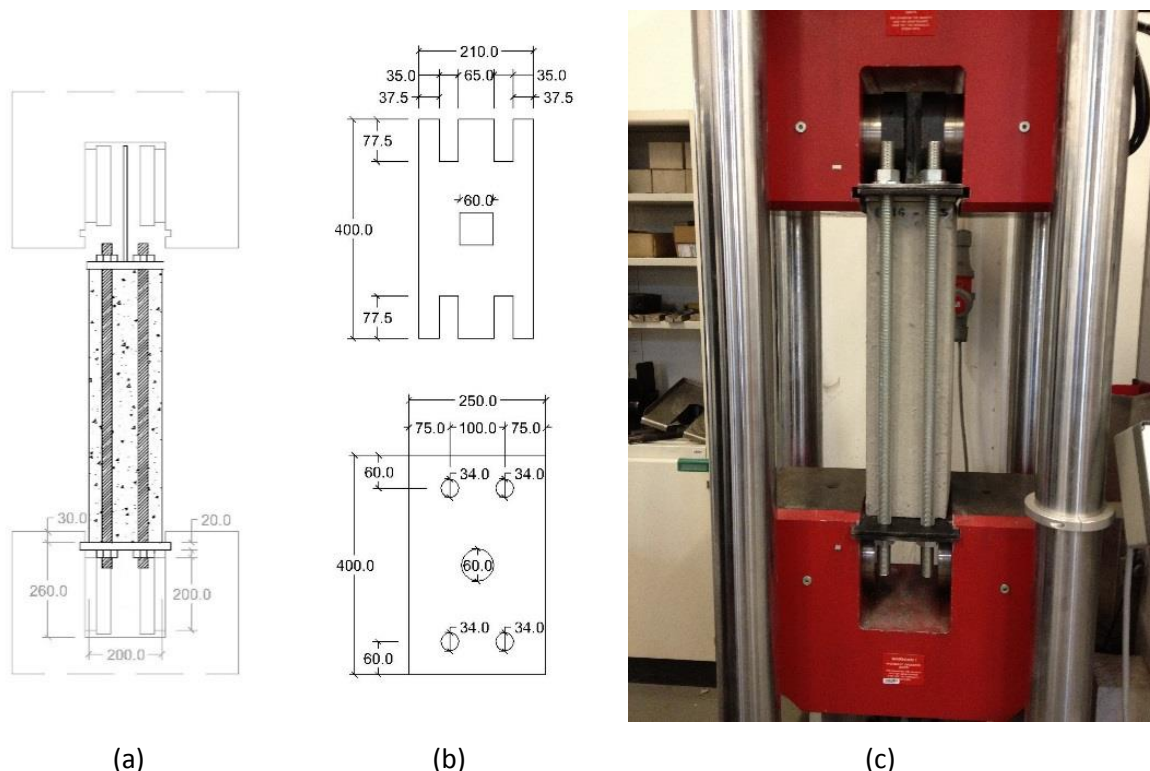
Ensaio arrancamento com longo comprimento de ancoragem: (a) corte representativo, (b) planta da chapa superior e inferior e (c) ensaio real
